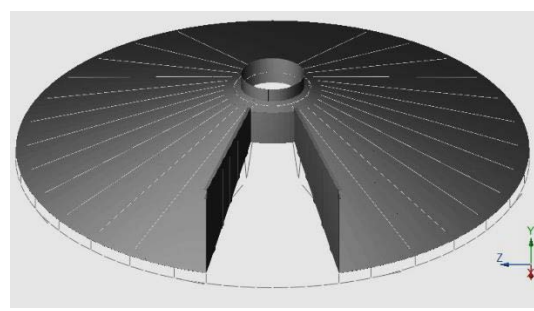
Nervios verticales y vigas soporte de piso filtrante.
